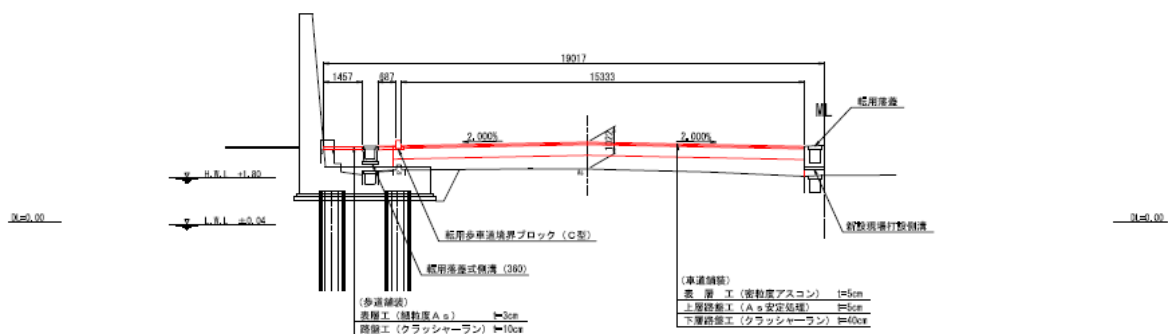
36 No. 1 朝日大川路線 (A) 標準横断面図 ANO. 14 (復旧後)
